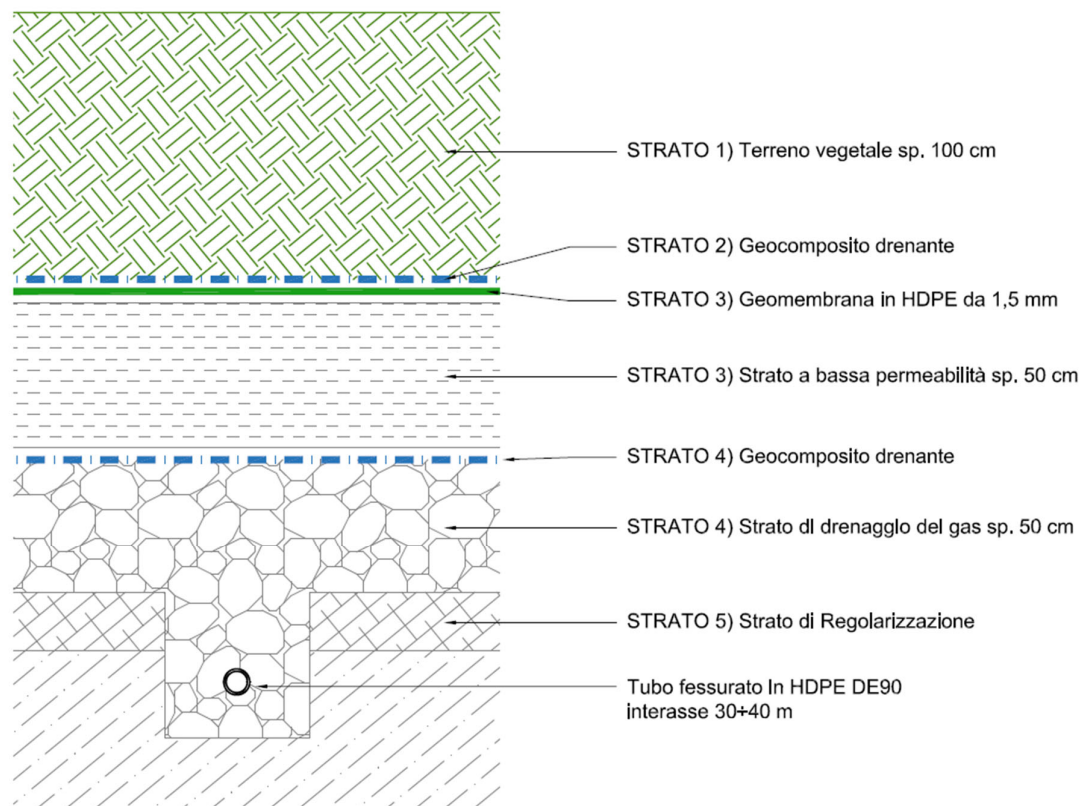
Pacchetto di copertura previsto nelle parti pianeggianti
